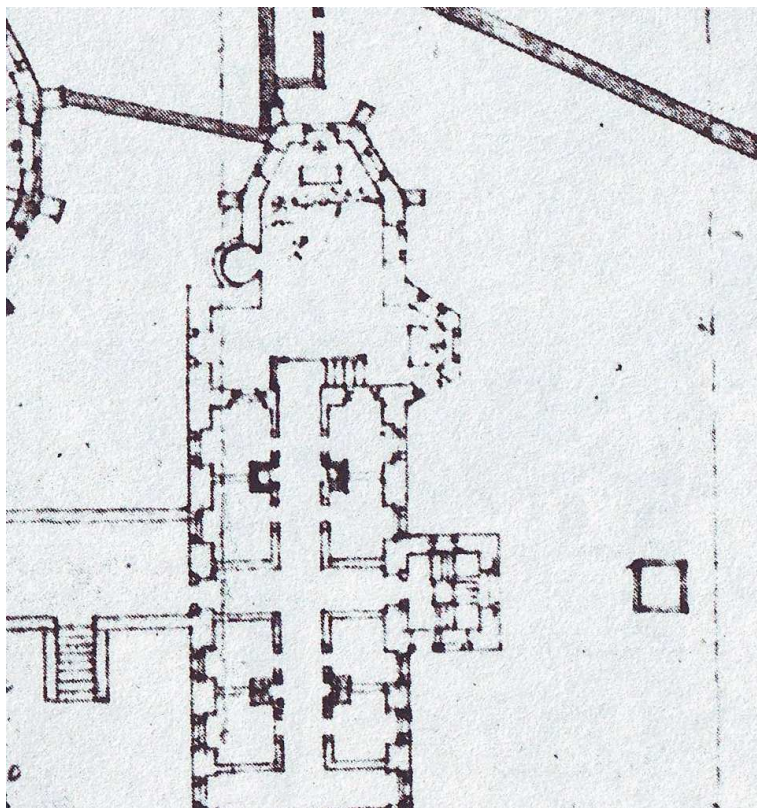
Stift Zwettl, Grundriss des Klosters im Jahre 1650, Baupläne Nr. II, Detail Infirmaryum/Nikolauskapelle.
